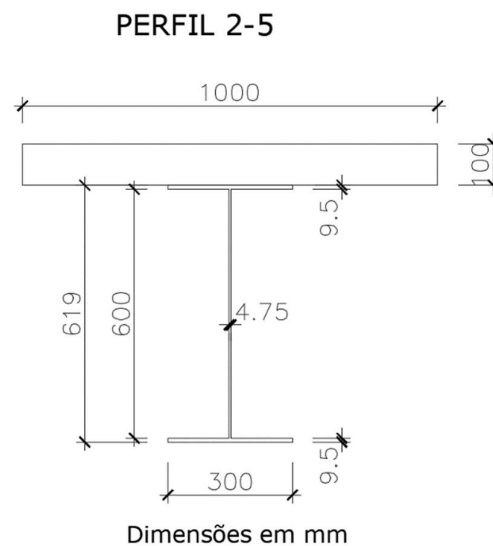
Dimensões, em mm, da seção transversal da viga mista 2-5 (SP).
